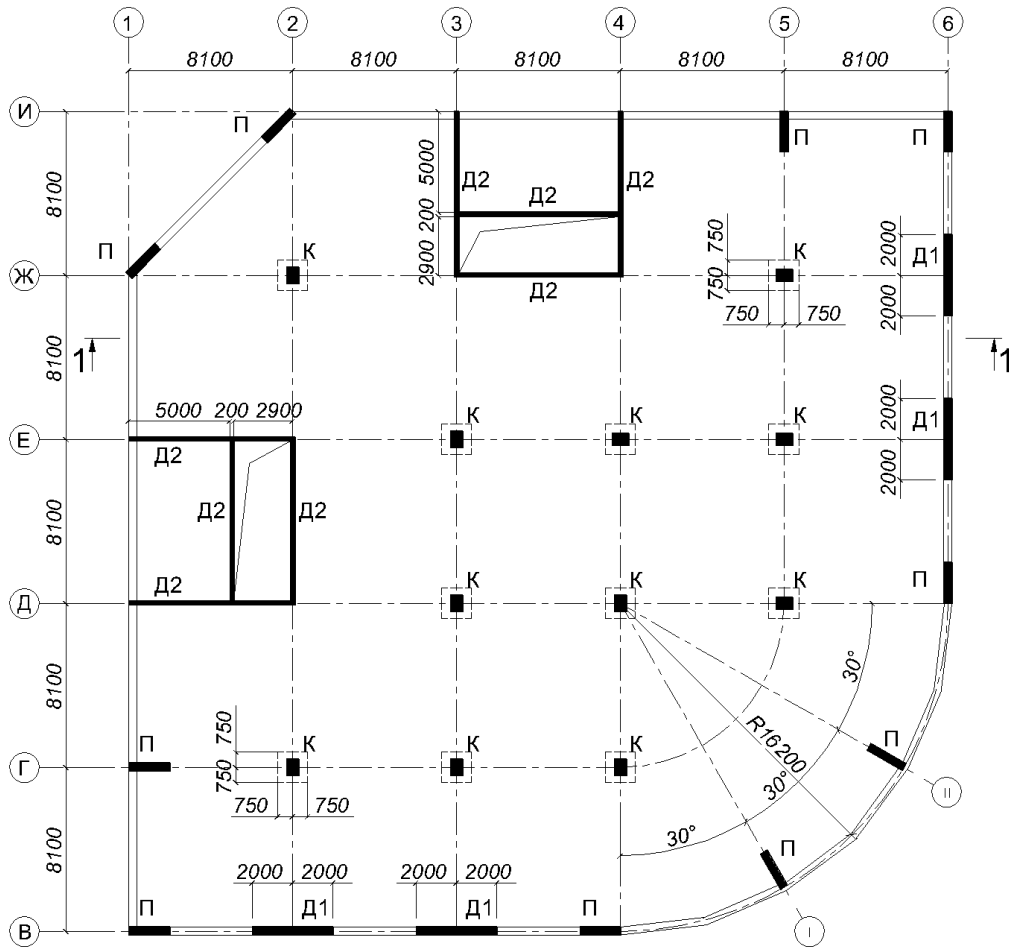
б. План типового этажа на отметках от 13.200 м до 46.200 м
